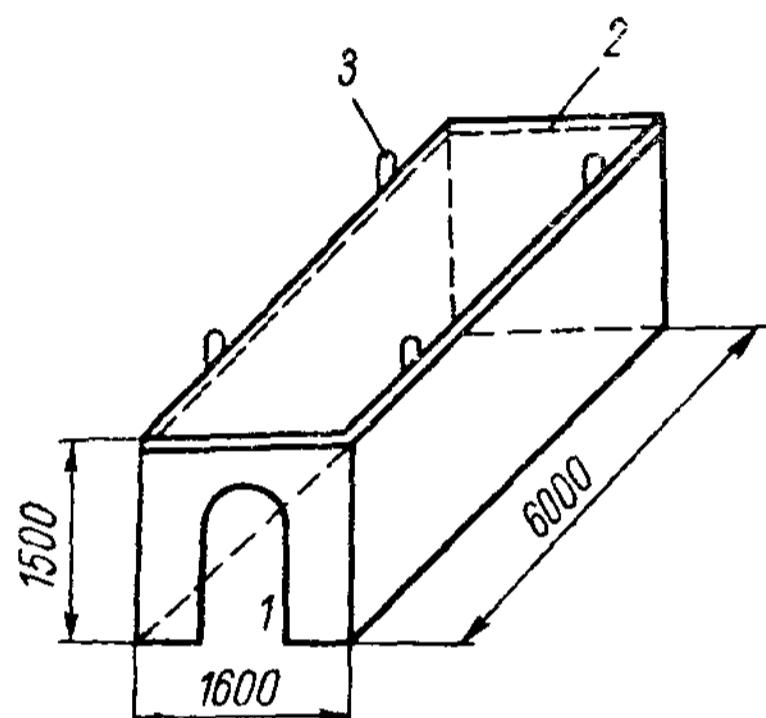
Металлический короб для укладки труб в водонасыщенных грунтах
